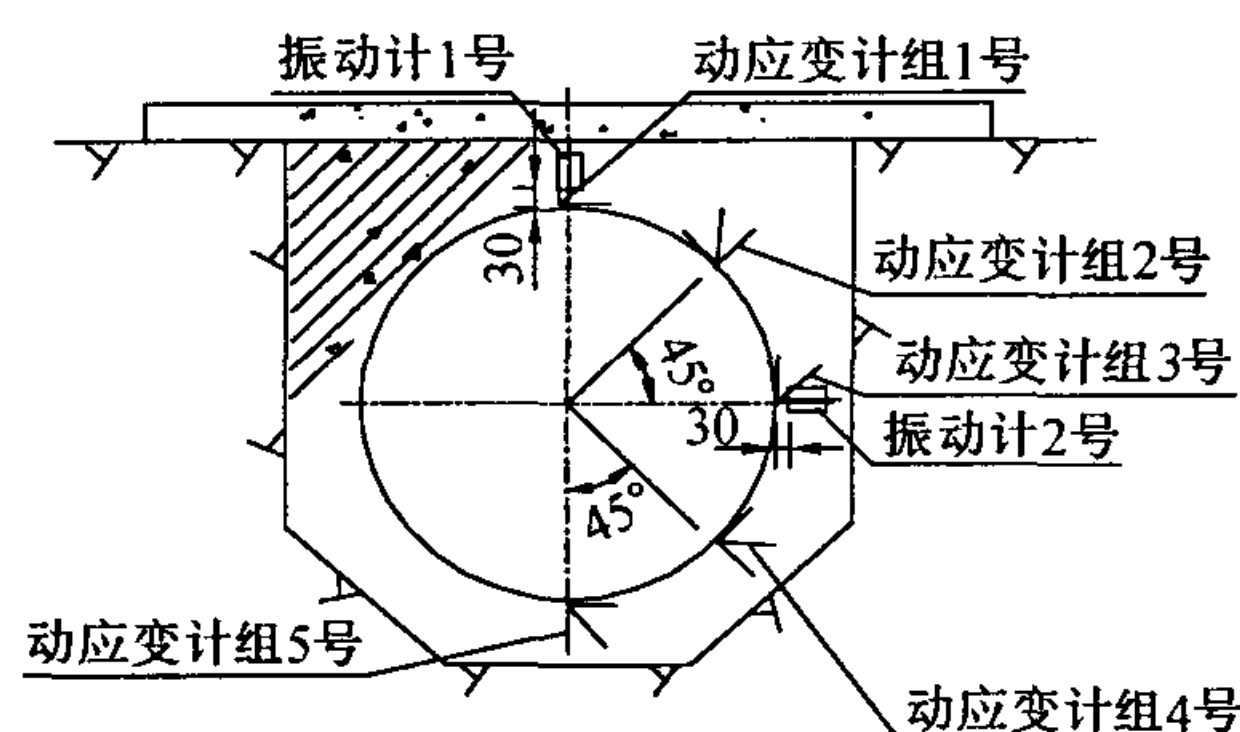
引水钢管断面监测仪器布置示意图(单位:cm)
